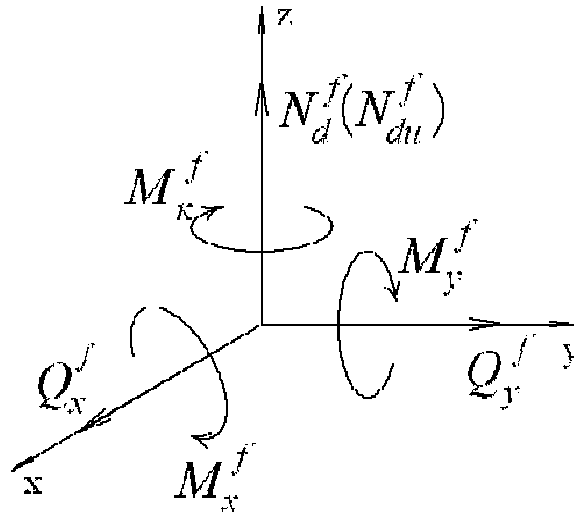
Схема приложения расчётных нагрузок на фундамент (нагрузки приложены в уровне опирания опоры на фундаментную конструкцию (в плоскости XOY)).
